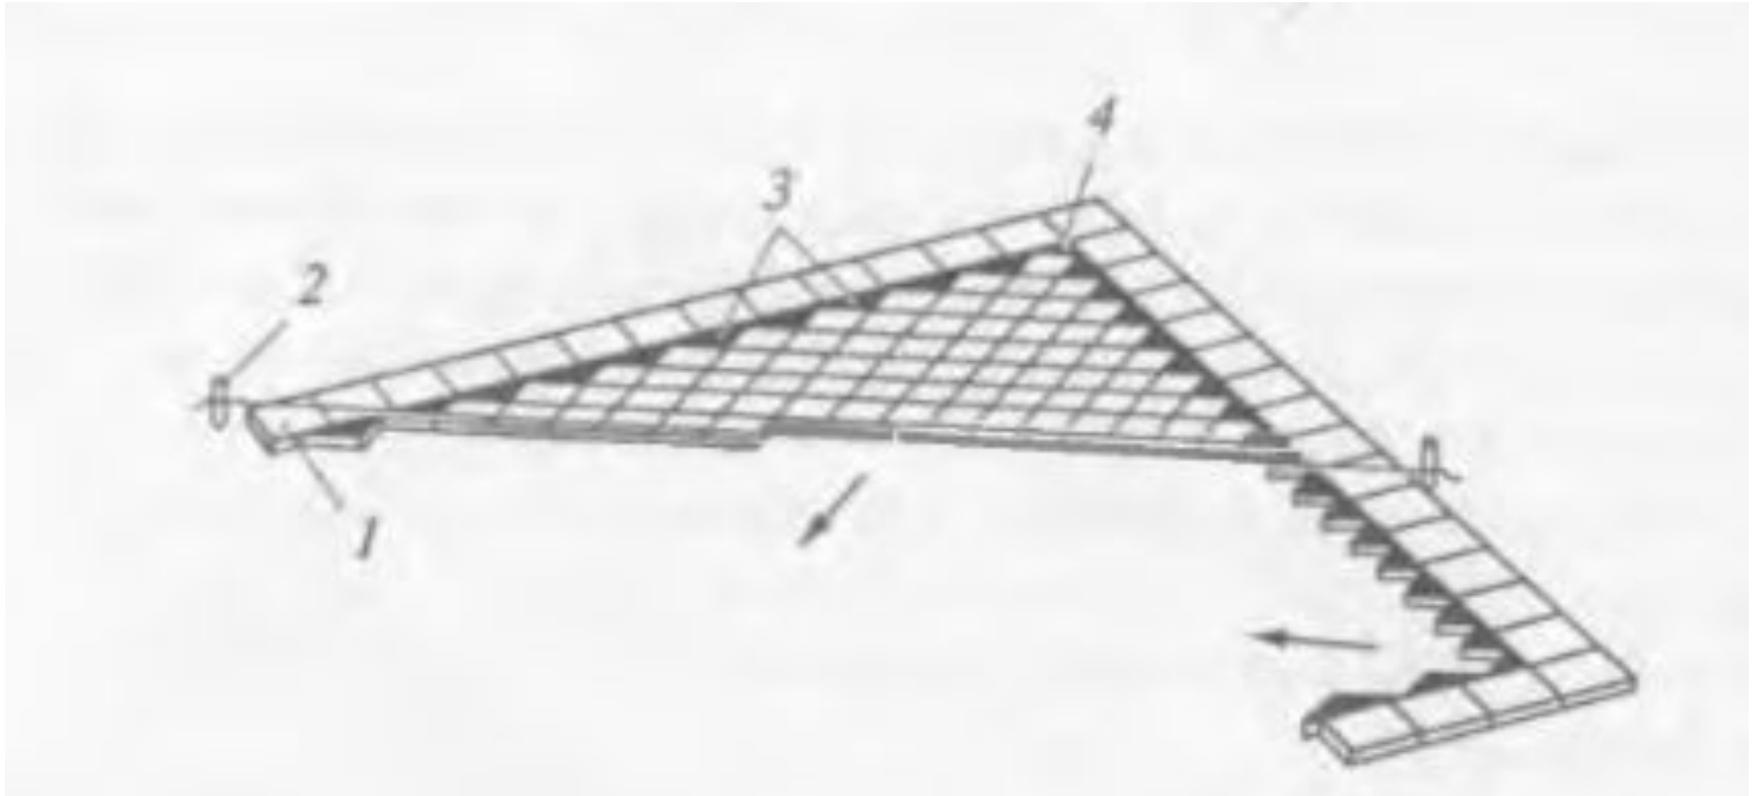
Настилка пола по диагонали: 1- фризовый ряд; 2— штырь с причальным шнуром; 3— треугольные плитки; 4 — вставка из четверти плитки
